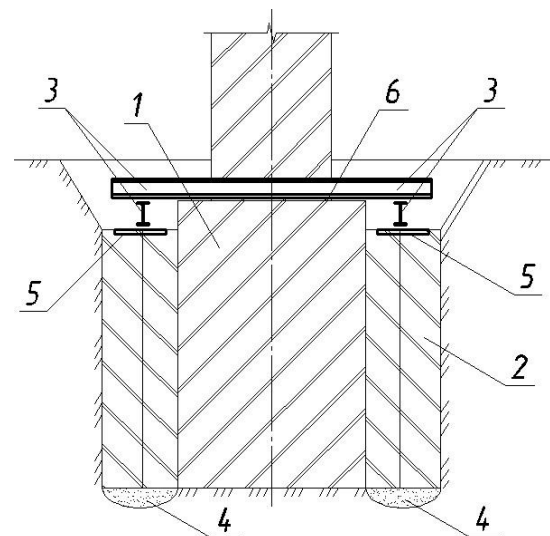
Збільшення опорної площі улаштуванням додаткової кам'яної кладки: 1 – посилюваний цегляний фундамент; 2 – додаткова цегляна кладка; 3 – металеві балки; 4 – ущільнений ґрунт; 5 – металеві упори; 6 – отвори в стіні, що
